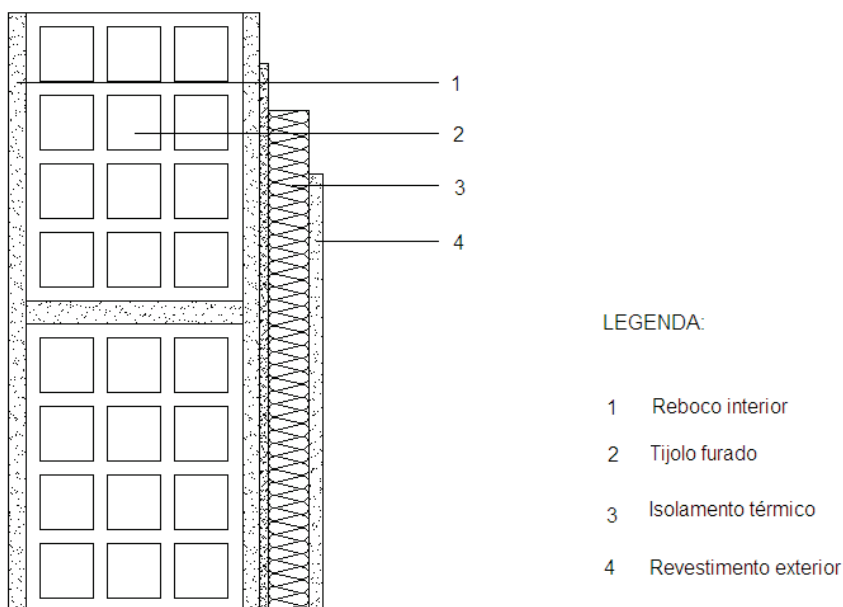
Pormenor construtivo da parede simples com isolamento térmico pelo exterior, ETICS.
